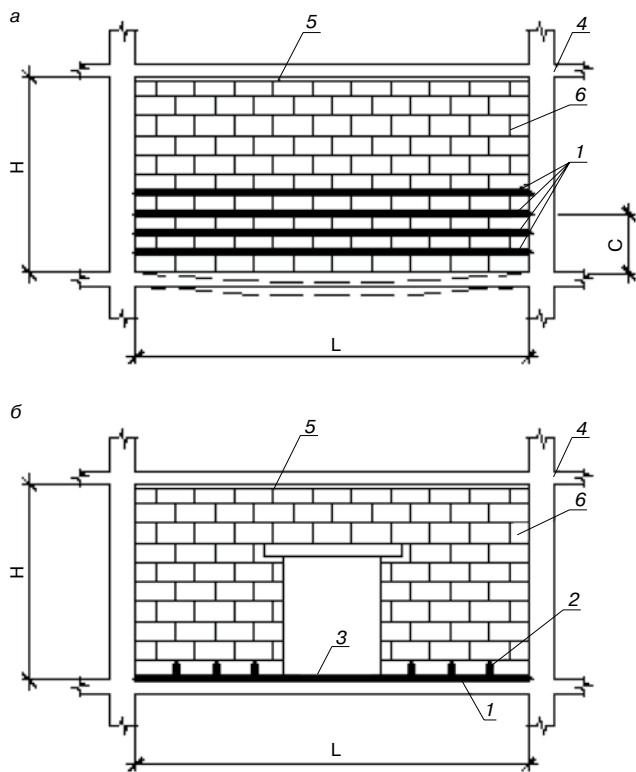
Способы армирования несущих каменных перегородок без дверного (а) и с дверным проемом (б): 1 – горизонтальная арматура; 2 – анкерные пластины; 3 – стяжка пола; 4 – железобетонный каркас; 5 – деформационный шов между перегородкой и перекрытием; 6 – перегородка
